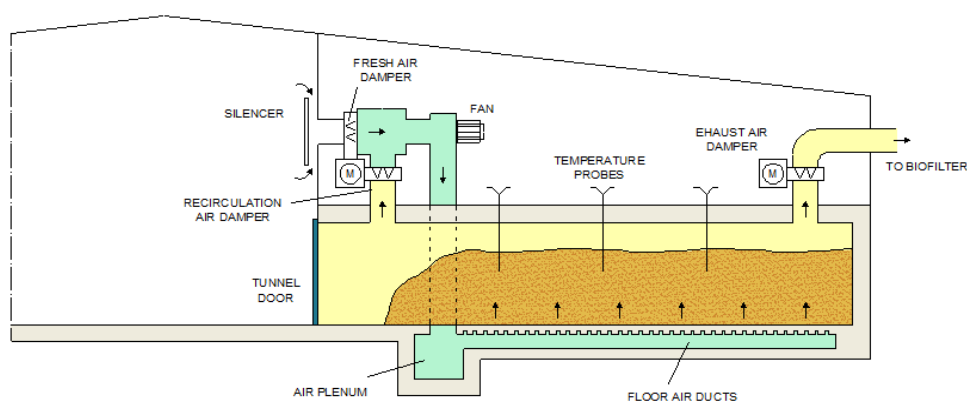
Schema tipico del sistema ventilazione biocella
